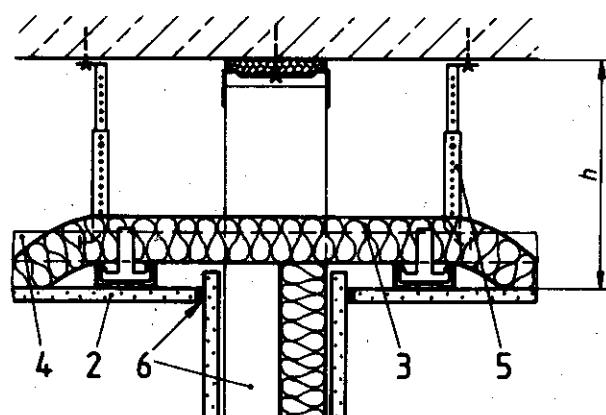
Trennwandanschluß an Massivdecke mit Trennung der Unterdecke in Decklage und Unterkonstruktion
